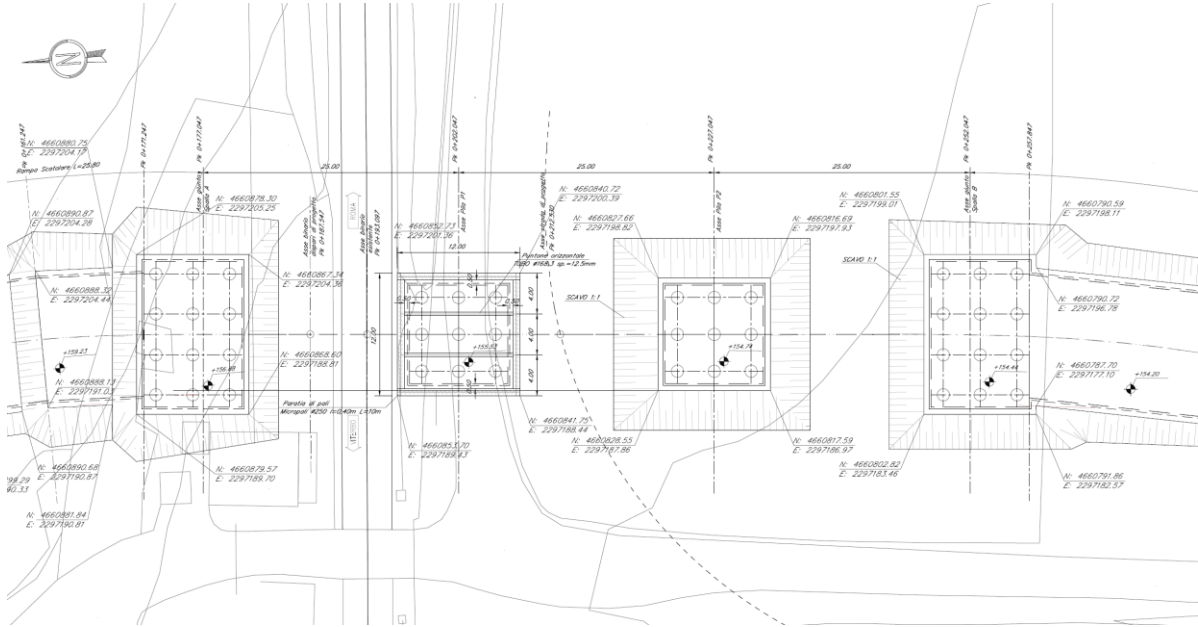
Ponte ferroviario IV01 al km 29+550: inquadramento planimetrico
